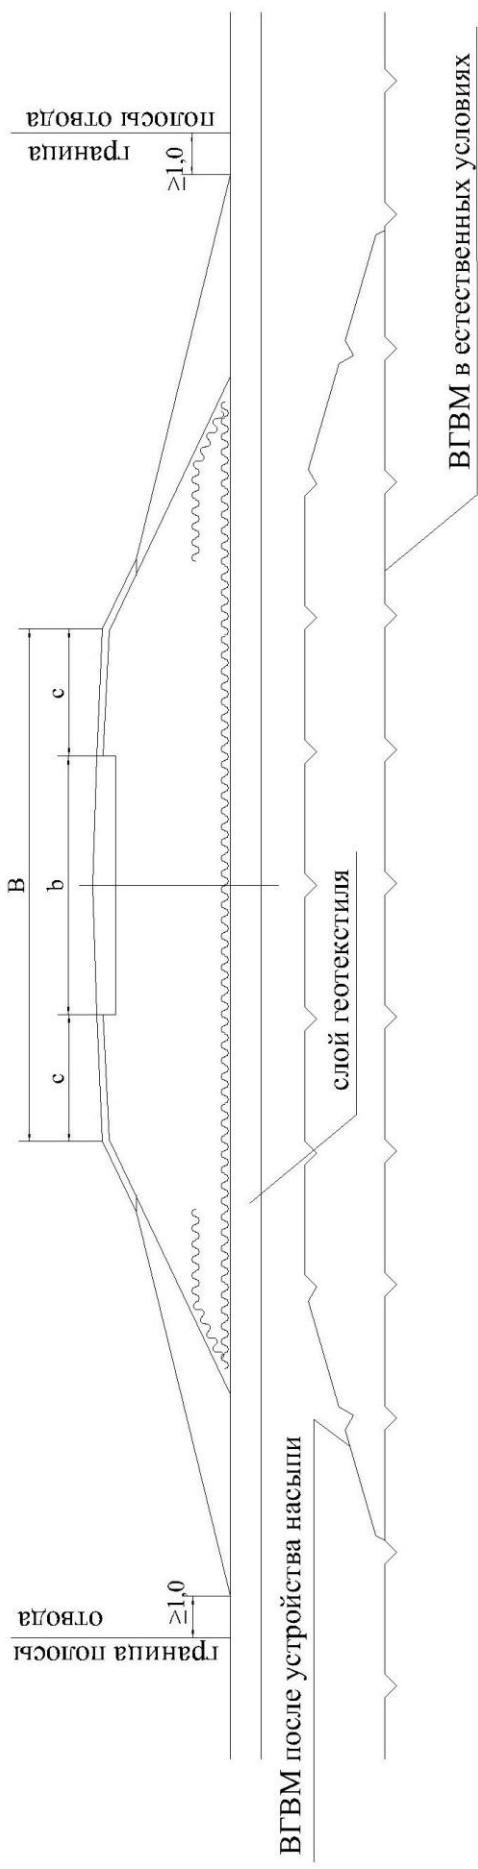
Насыпи с применением армирующих слоев из геотекстиля тип 12-М
